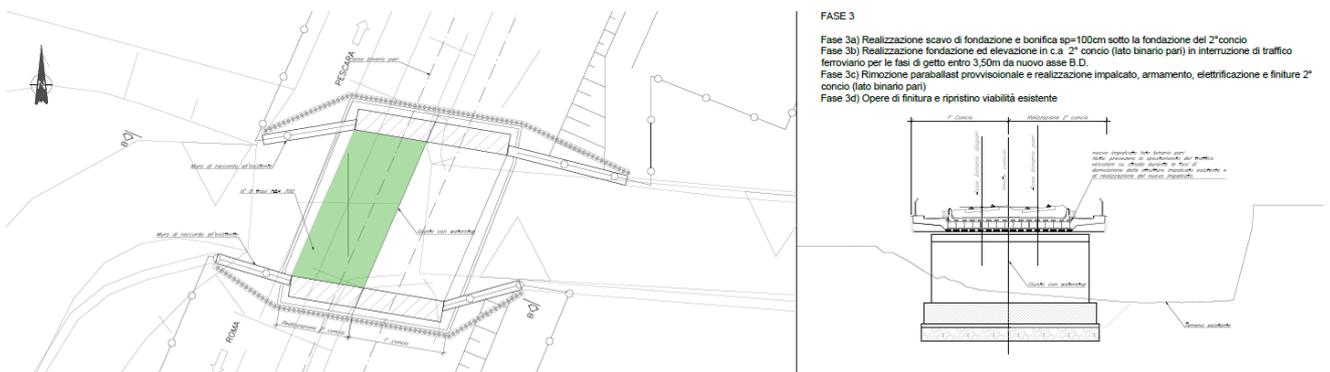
SL26 – Fase realizzativa 3, pianta e sezione sottopasso
